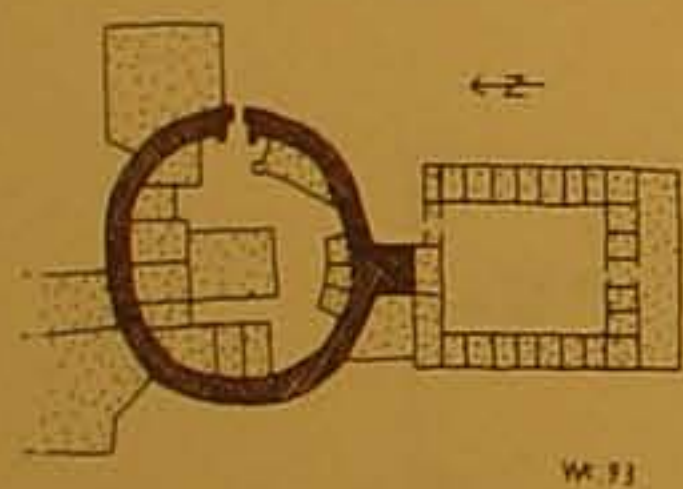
Badeh, Plan und Schnitt der Dorfburg
